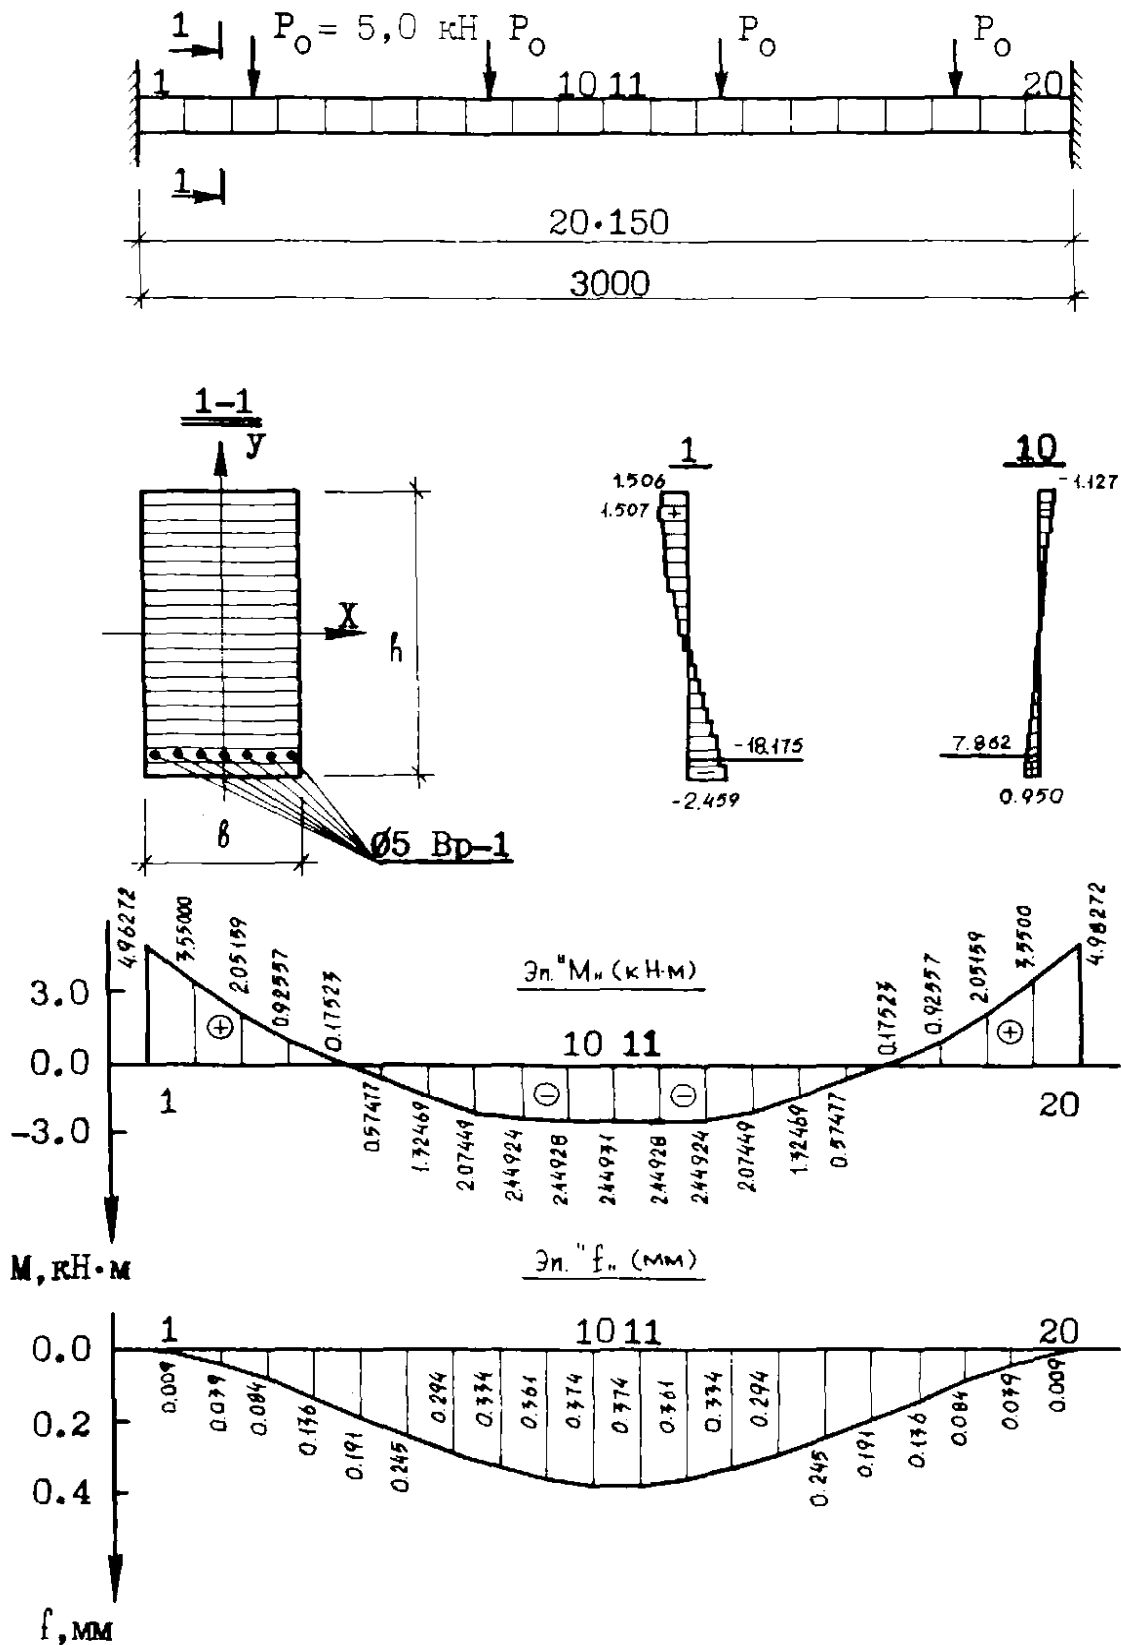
Эпюры напряженно-деформированное состояние сборных железобетонных плит перекрытий с жесткой заделкой
